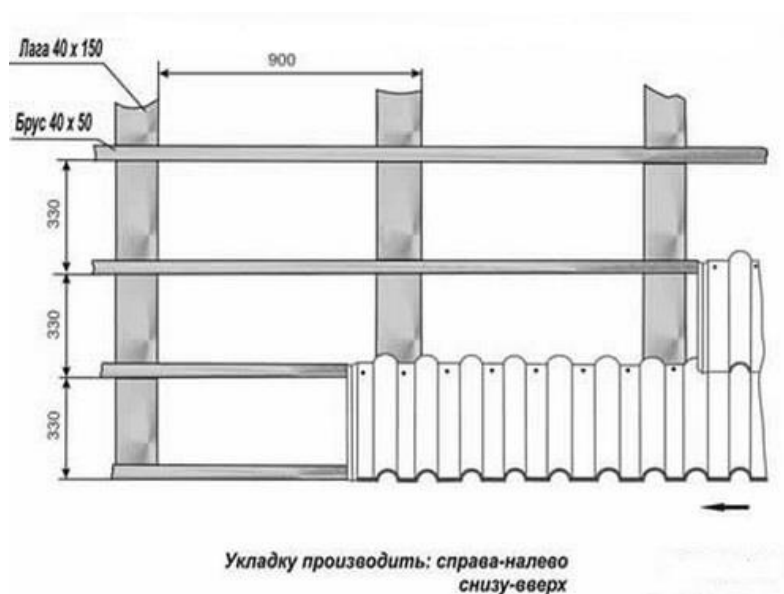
Схема укладки стеклянной черепицы [1]
